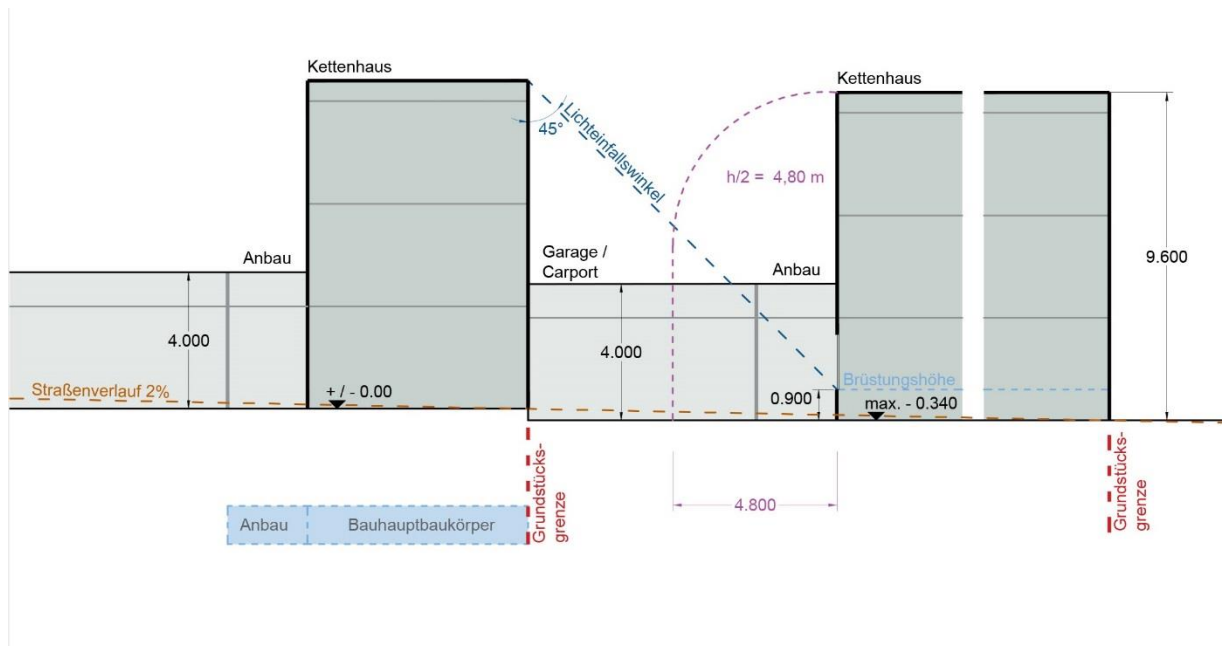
Schnittansicht Kettenhäuser – Abstandsermittlung der benachbarten Bauhauptkörper, o. M.
